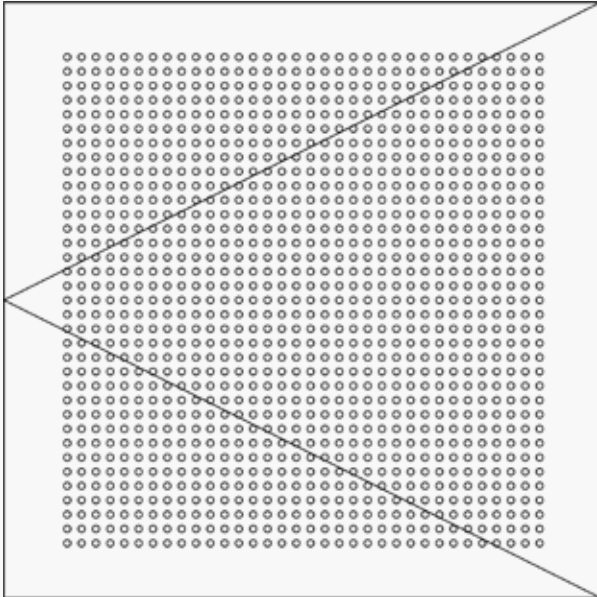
Corte y elevación del puertas acústicas abatible. Proyecto Future Edu Space
